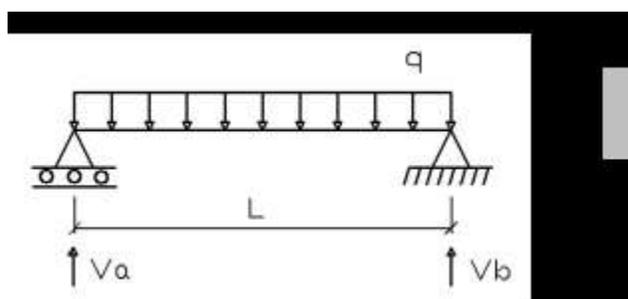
Viga simplesmente apoiada com carga uniformemente distribuída
